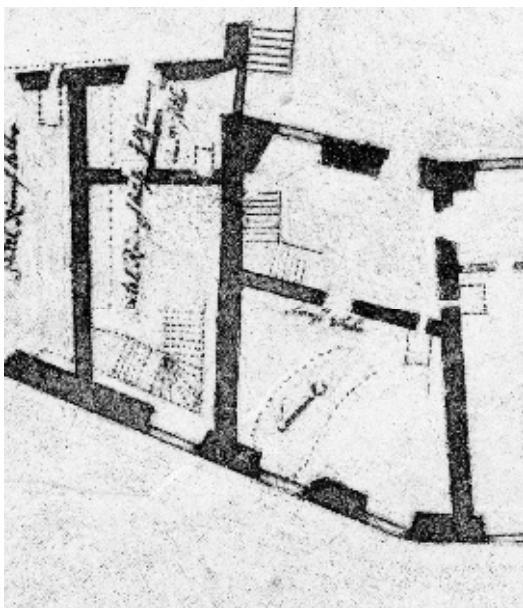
und 7: Grundrisse 1722 und 1844 (Ausschnitte)
